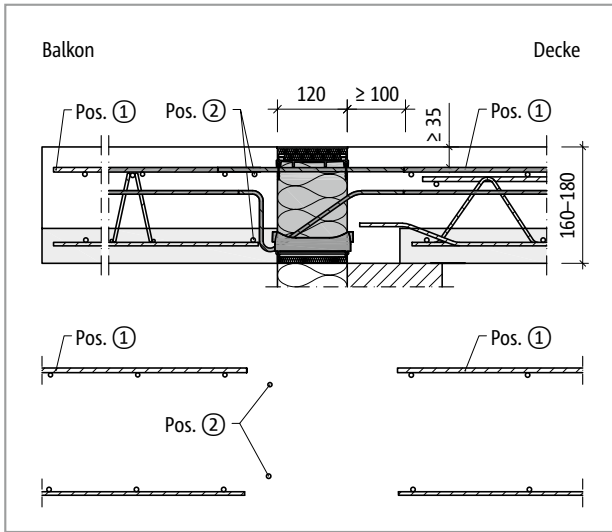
Schöck Isokorb® XT Typ K-F: Bauseitige Bewehrung bei Balkonplattendicke  $h = 160\text{--}180\text{ mm}$
